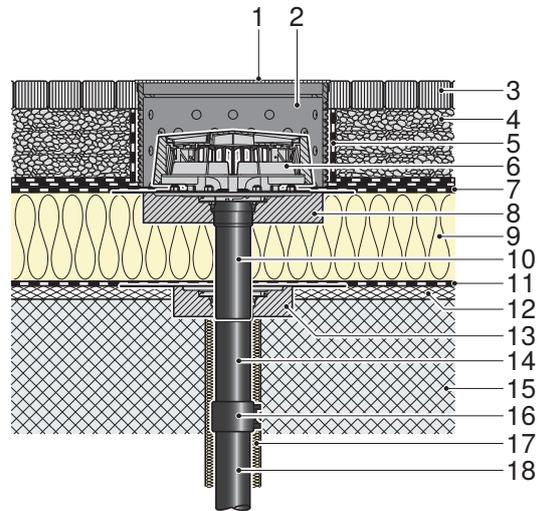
Монтаж на изолированной жесткой кровле с пароизоляцией и кровельным покрытием, выдерживающим вес людей
